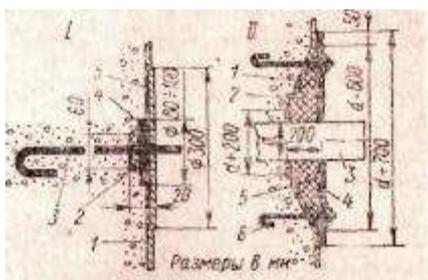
Устройство сопряжений штукатурной гидроизоляции с закладными деталями (к п. 2.26)
